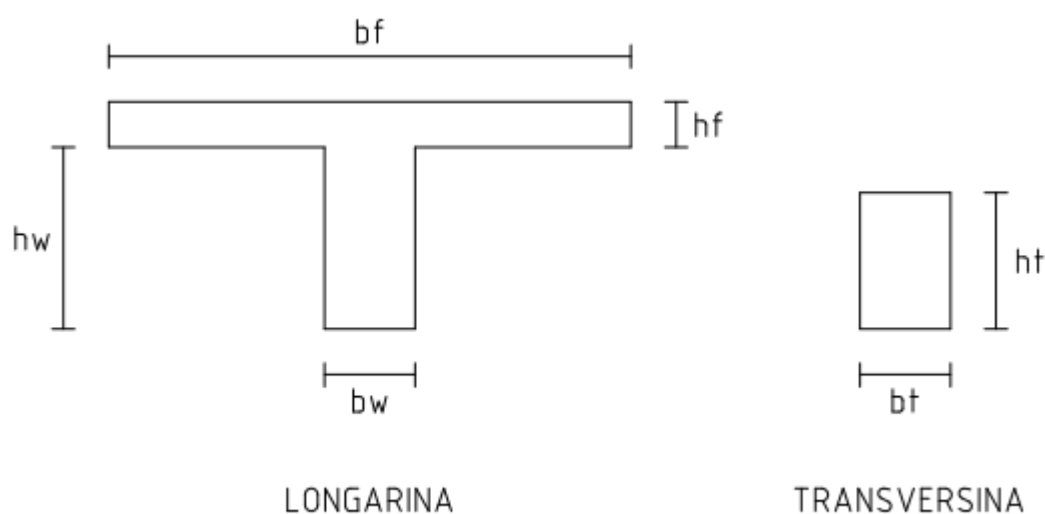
Dimensões das vigas longarinas e transversina da ponte
